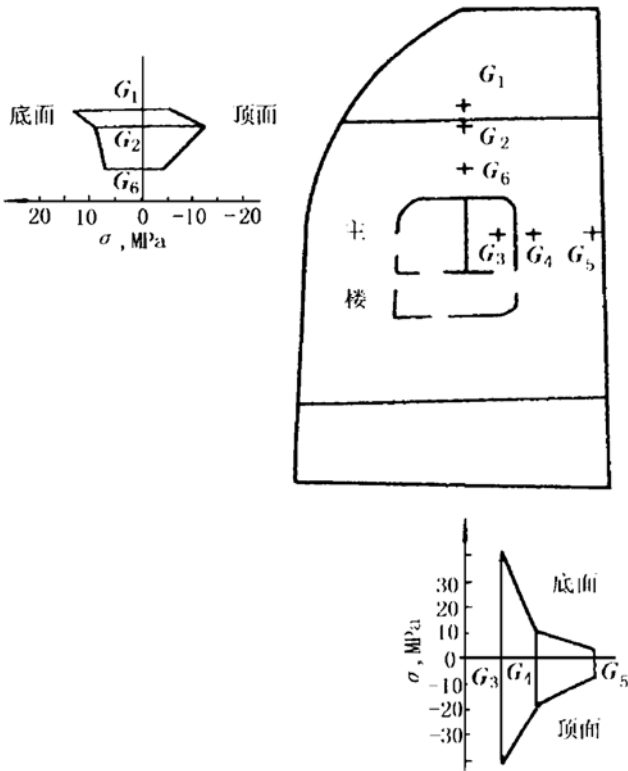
钢筋应力计布置图及筏板顶底面钢筋应力值
